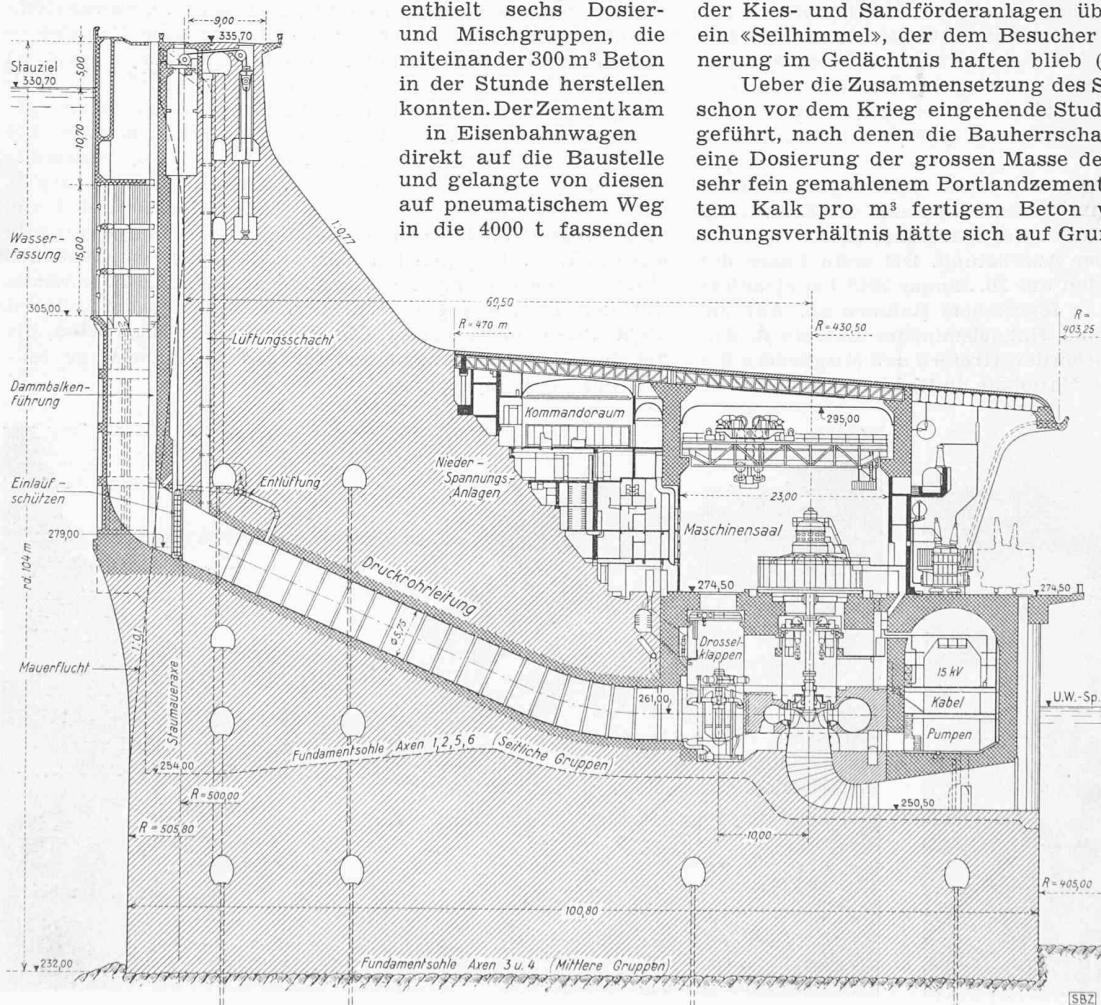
Stauwand und Maschinenhaus Génissiat, Querschnitt 1:800
